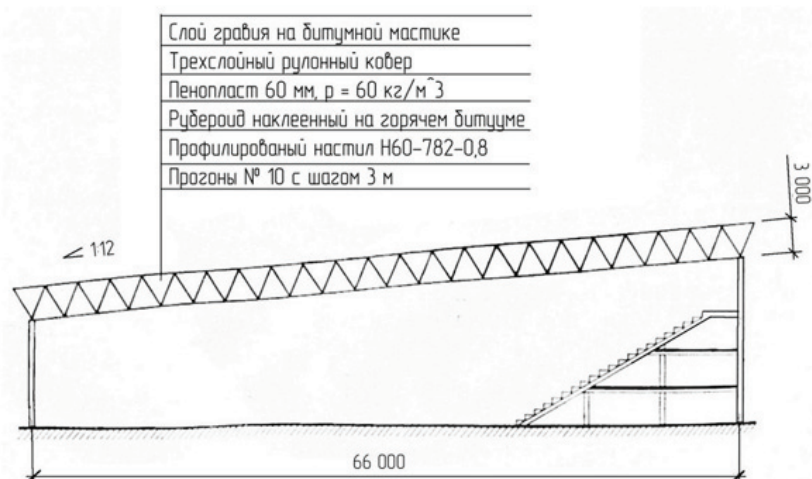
Поперечный разрез спортивно-демонстрационного зала, перекрытого структурной плитой из пентаэдров
